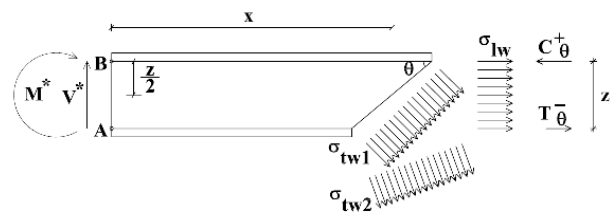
Tronco di trave, sezionato all'estremità con piano parallelo alla direzione θ dei campi di compressione del calcestruzzo d'anima
